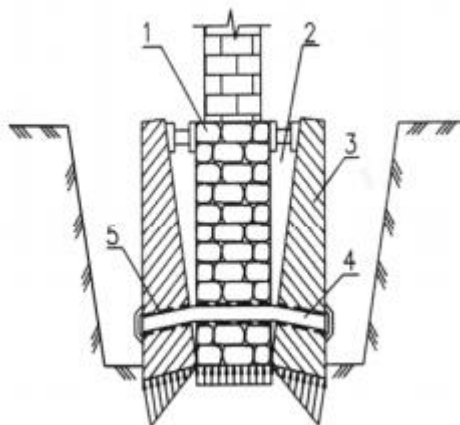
Усиление фундаментов дополнительными блоками, обжимающими грунты оснований при их повороте:
